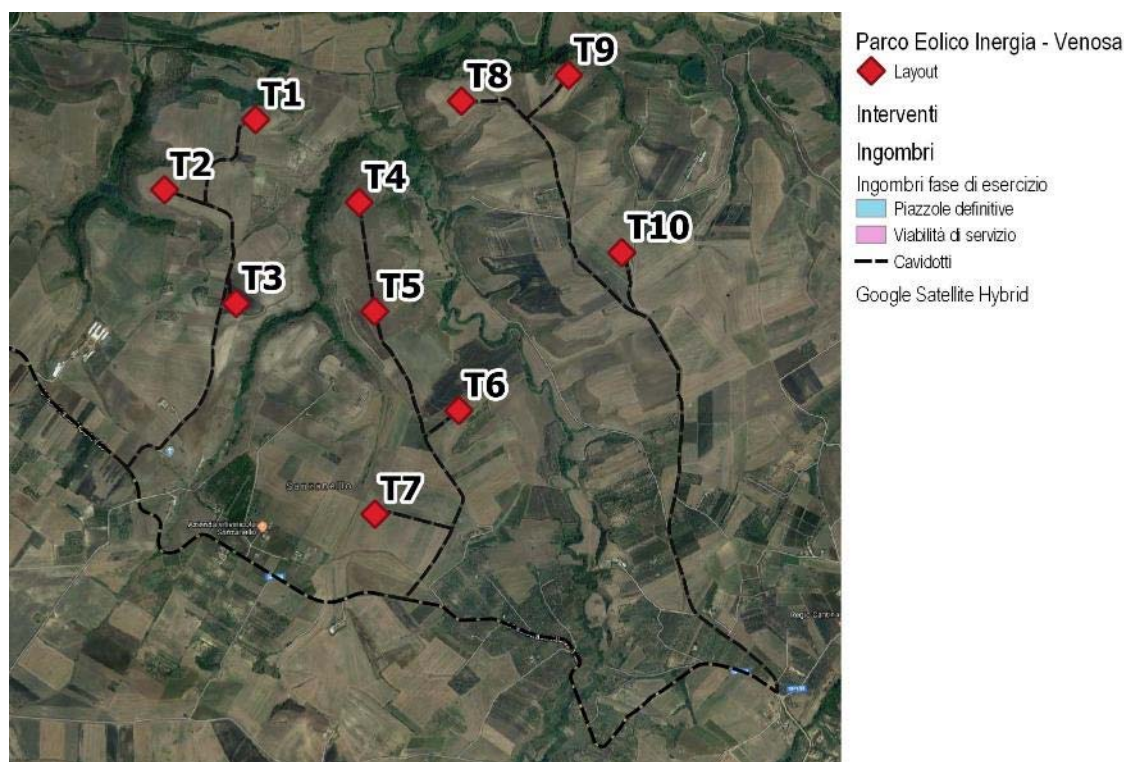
Planimetria con indicazione delle aree occupate in fase di esercizio
